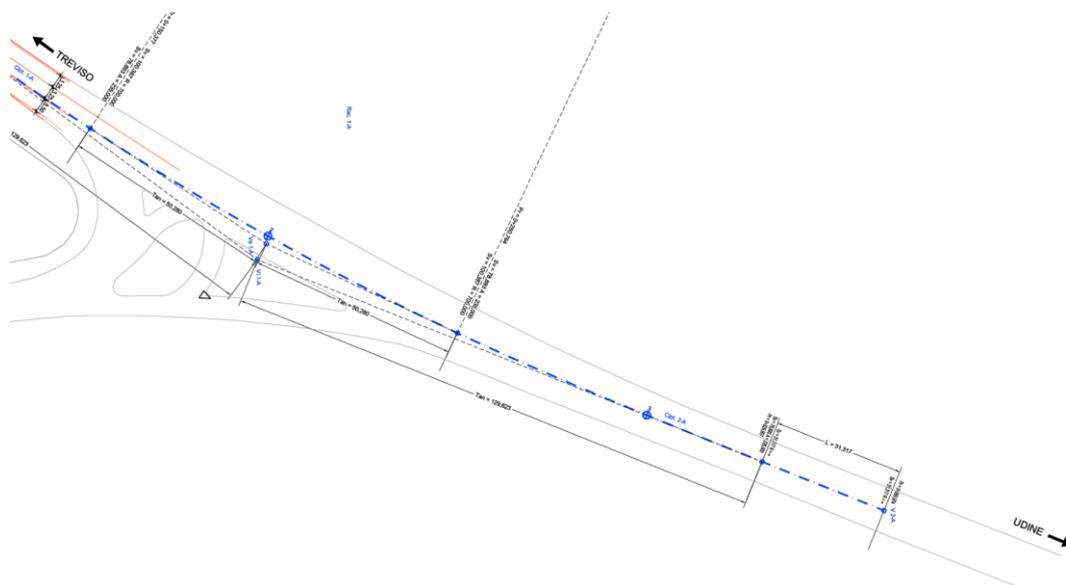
Andamento planimetrico riqualificazione tracciato S.S. n. 13
